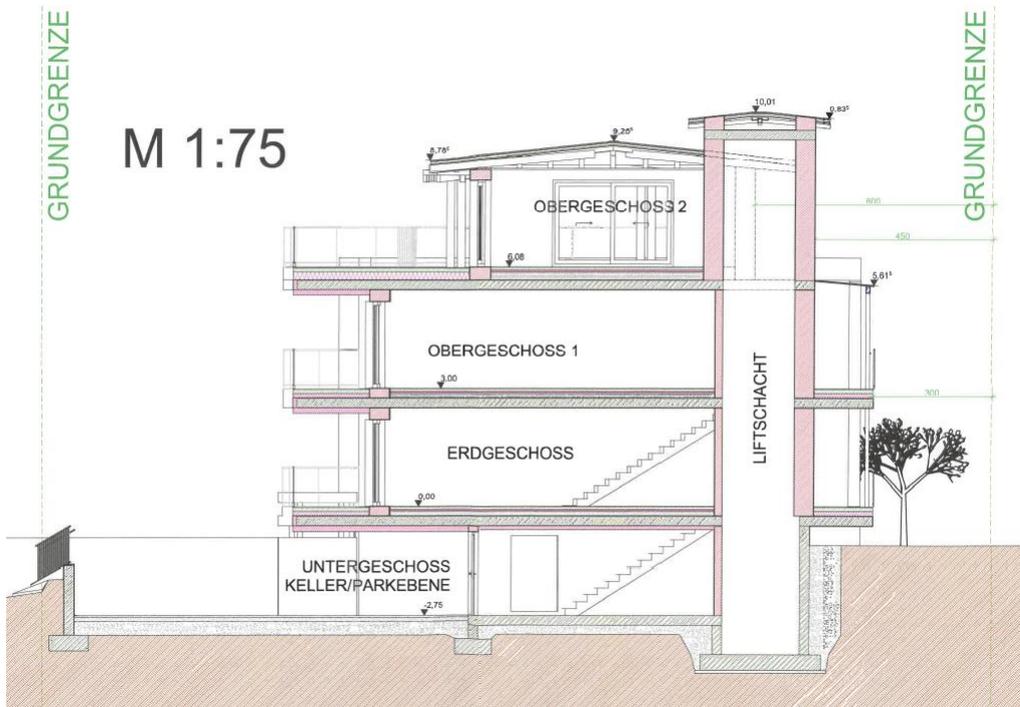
Schnitt gem. Entwurf Bebauungsstudie
